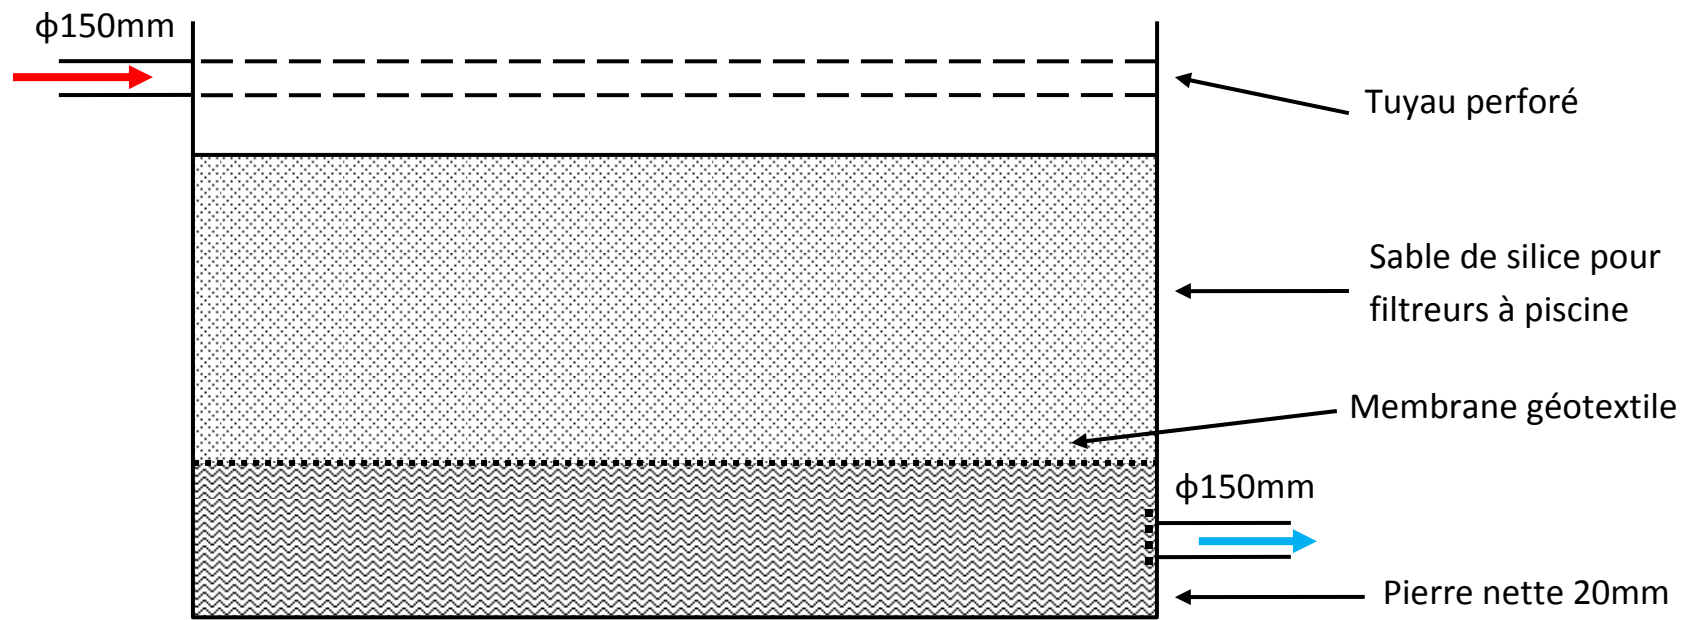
vue en coupe du dispositif de filtration (« boîte de pierre »)
